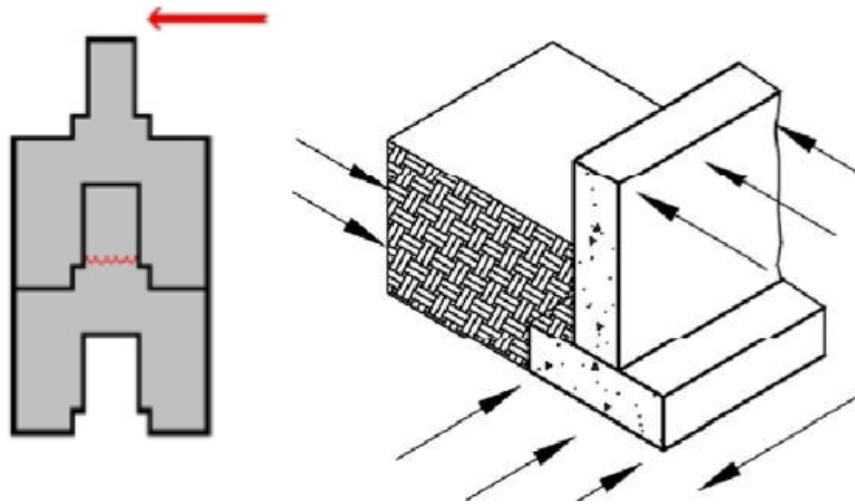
Bloque tipo del estudio de Laster visto en alzado
